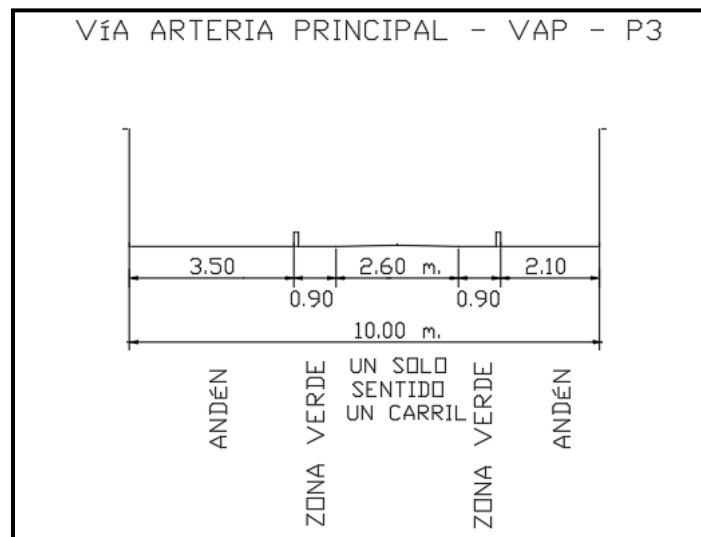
Sección vial 3-3'. Fuente: Elaboración propia.
